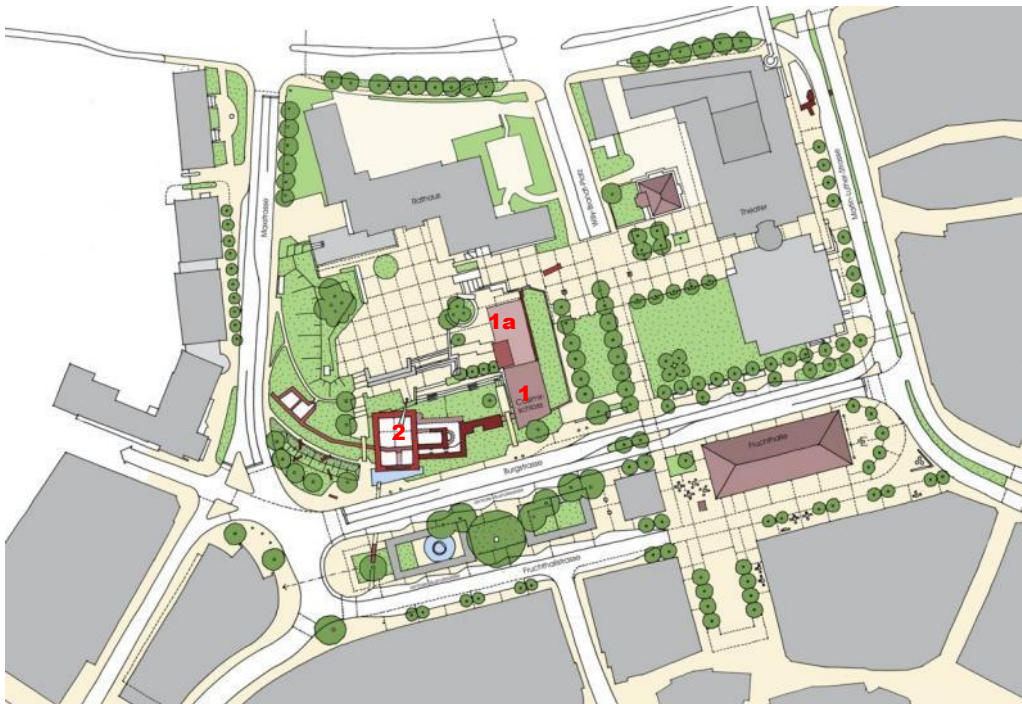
Plan des Rathausumfeldes mit Casimirschloss und Kaiserpfalz¹
